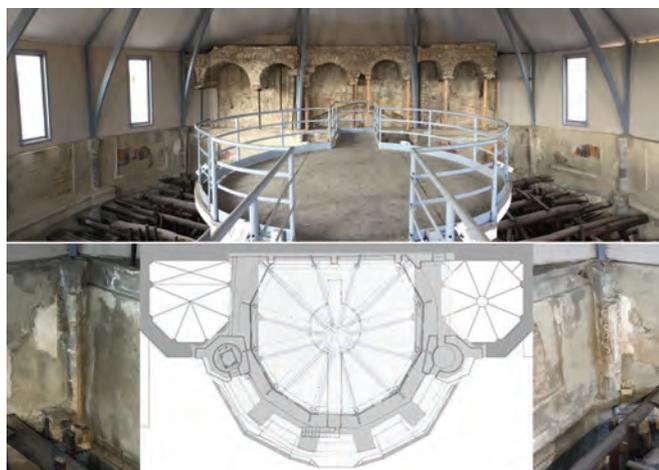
Napoli. Duomo, sottotetto dell'abside, i resti delle nervature della cupola tra parete frontale e laterali, sovrapposizione del rilievo del sottotetto sulla pianta dell'abside (foto ed elaborazione dell'autrice sulla base dei rilievi in R. Di Stefano, *La cattedrale...*, cit., figg. 36, 182, 166, 185).
